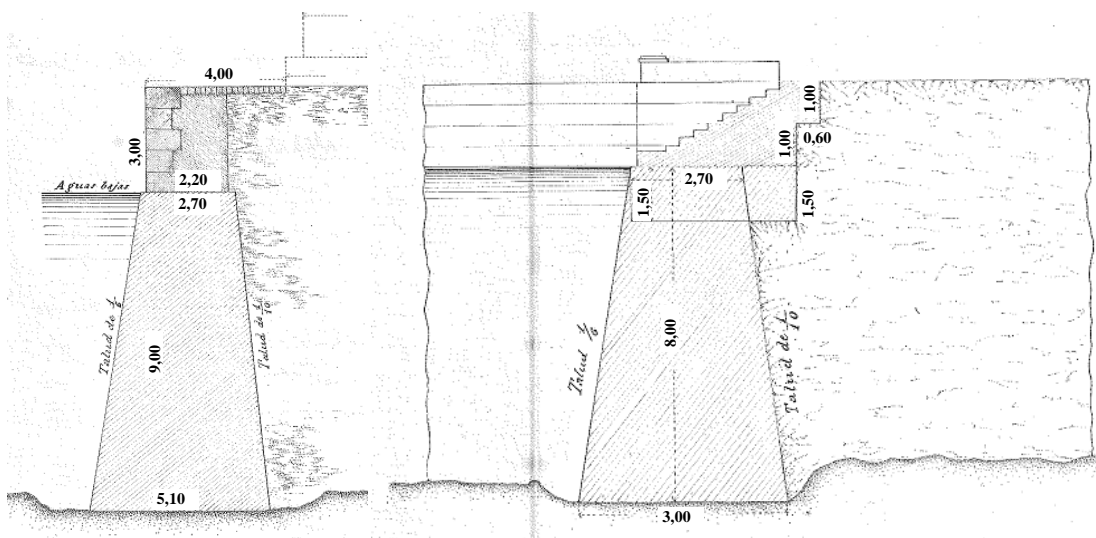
Diferentes secciones del muro construido con hormigón en masa (Bellido, 1882).
